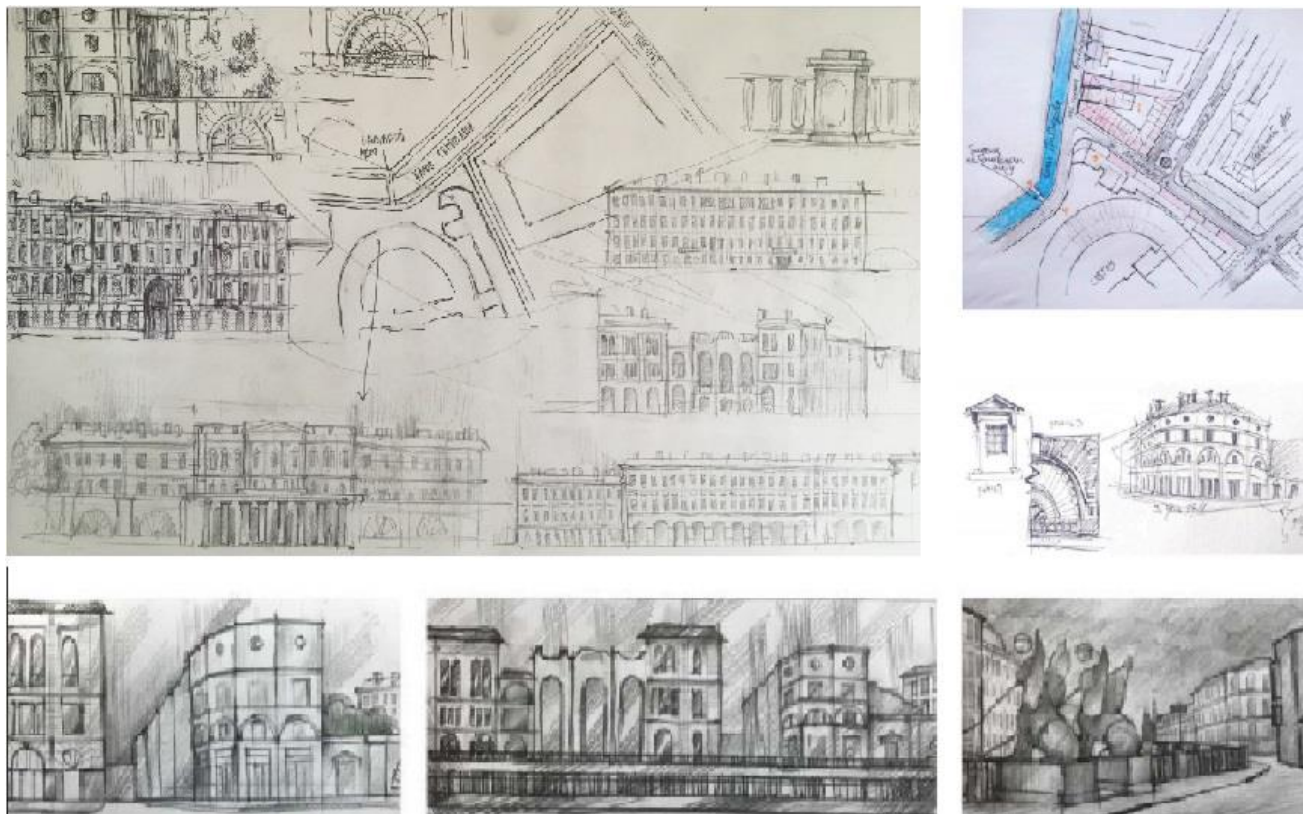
План участка набережной канала Грибоедова, зарисовки фасадов зданий и отдельных участков набережной.
